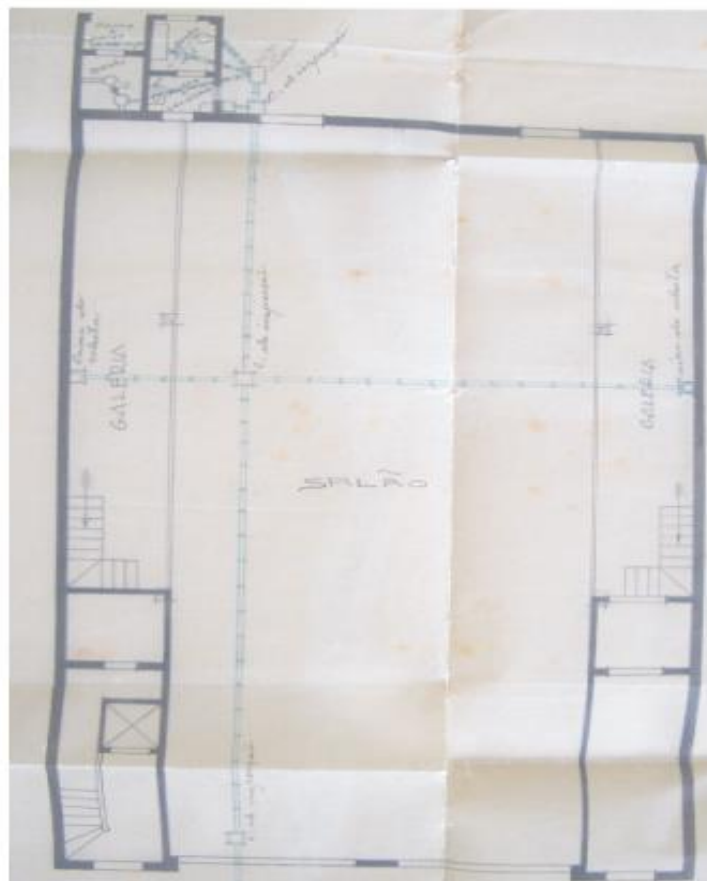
Planta do pavimento térreo do projeto original de 1937. (Fonte: SPU)
